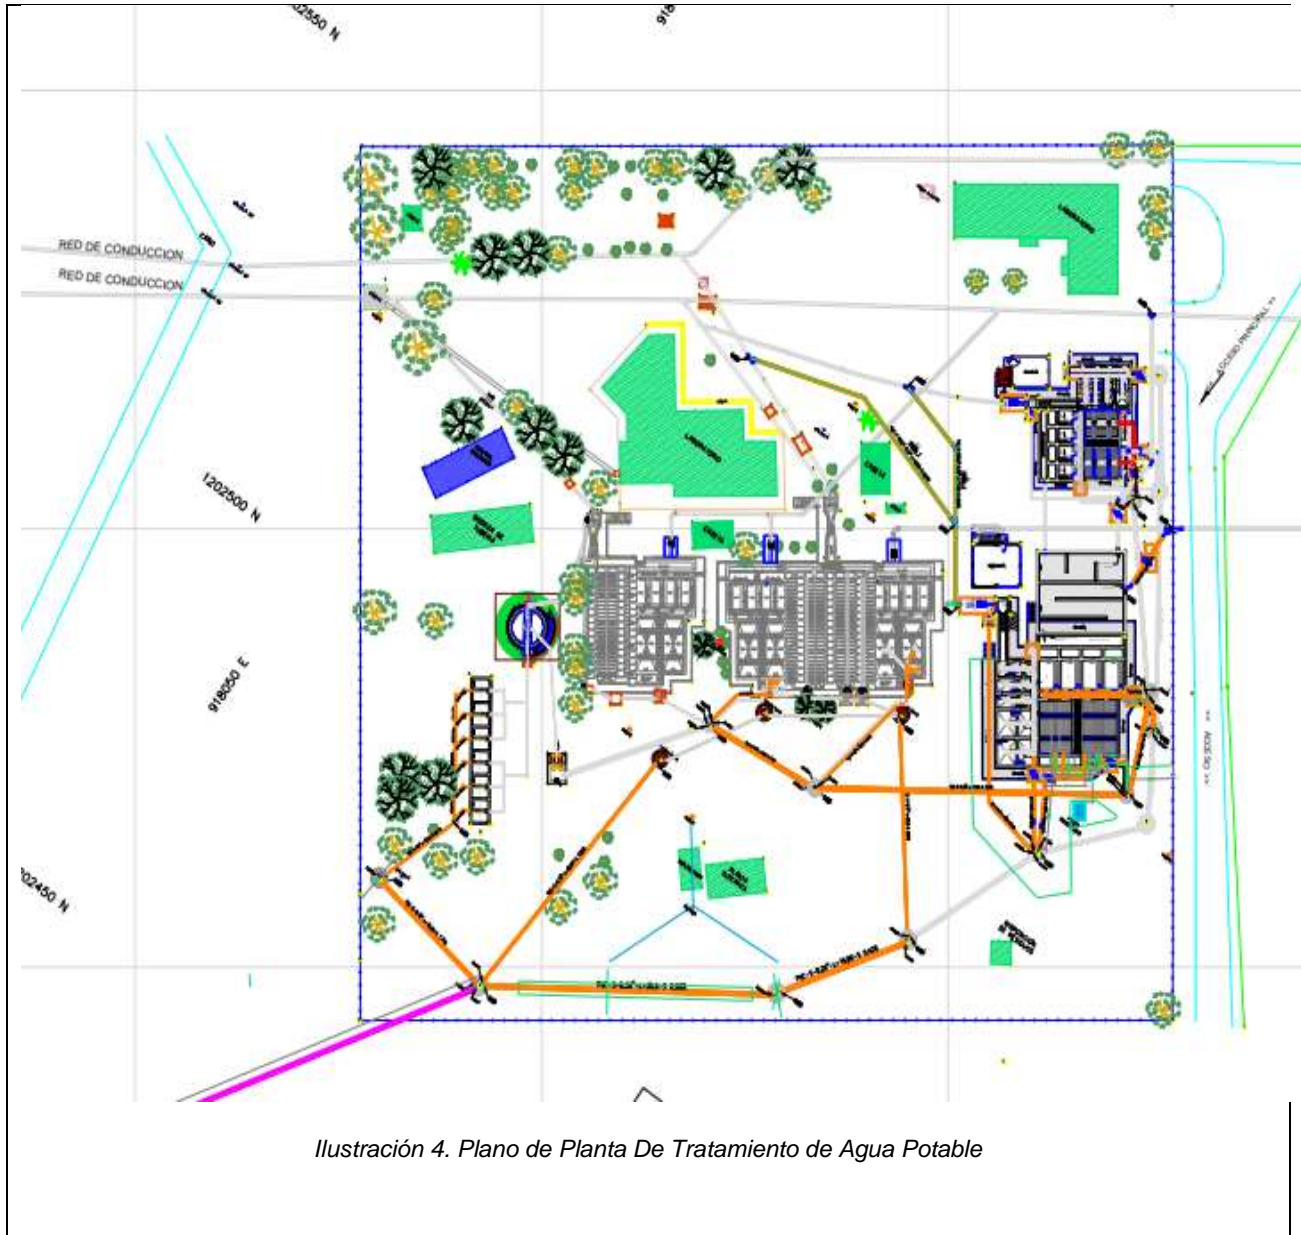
Plano de Planta De Tratamiento de Agua Potable
